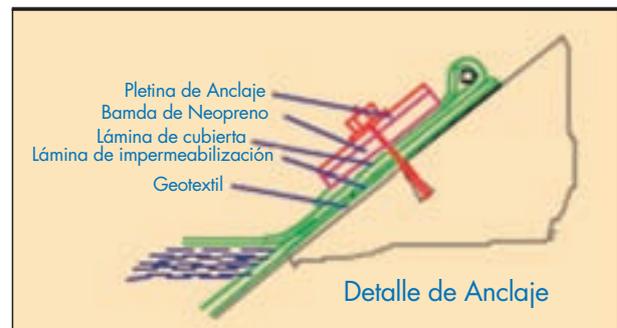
Detalle de Anclaje de la cubierta flotante.
